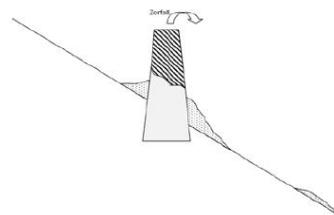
Rückgebaute Steinmauer gegen Lawinen.
